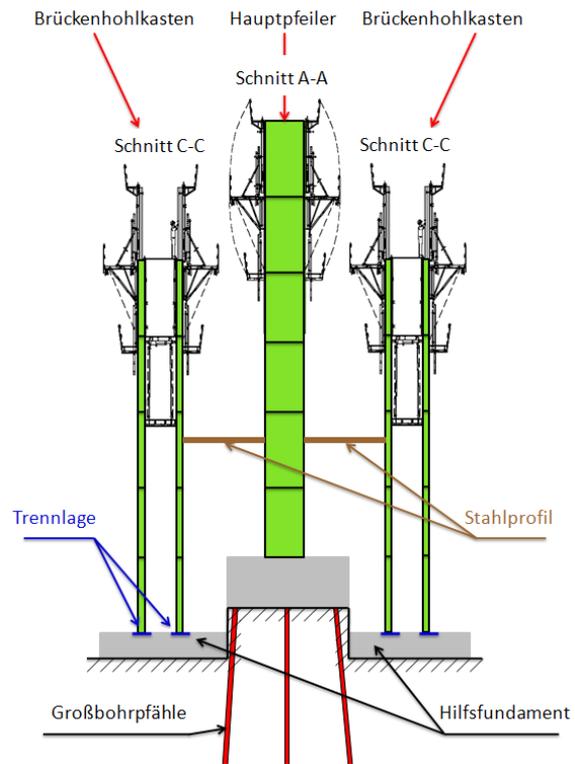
Anschluss- Brückenhohlkasten an Hilfsfundament
